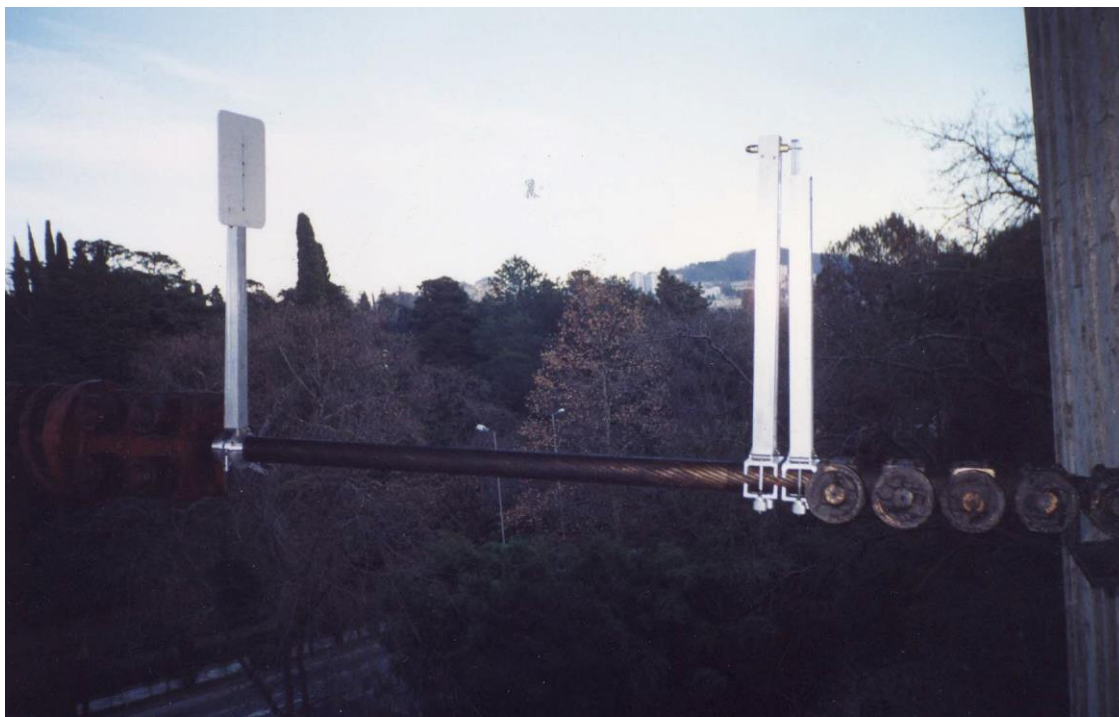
Общий вид устройства для замера кручения несущего каната закрытой конструкции
